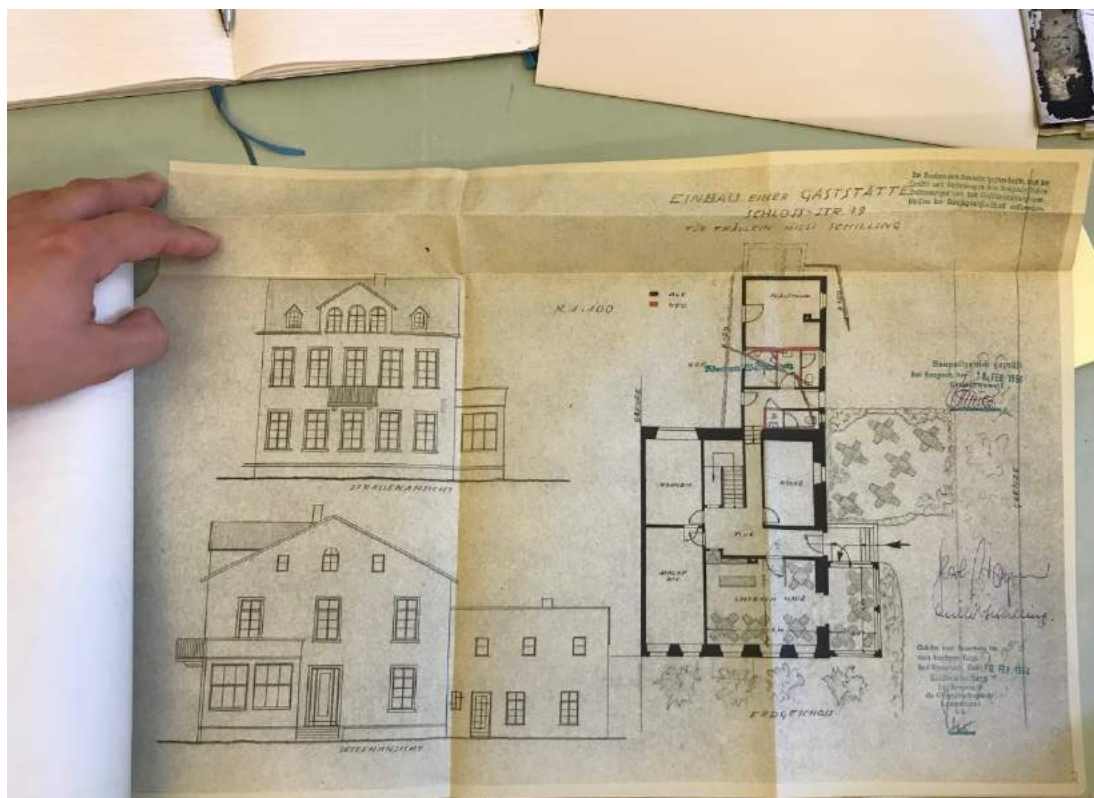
Schlosstraße 19 Bauplan Gaststätte im EG
